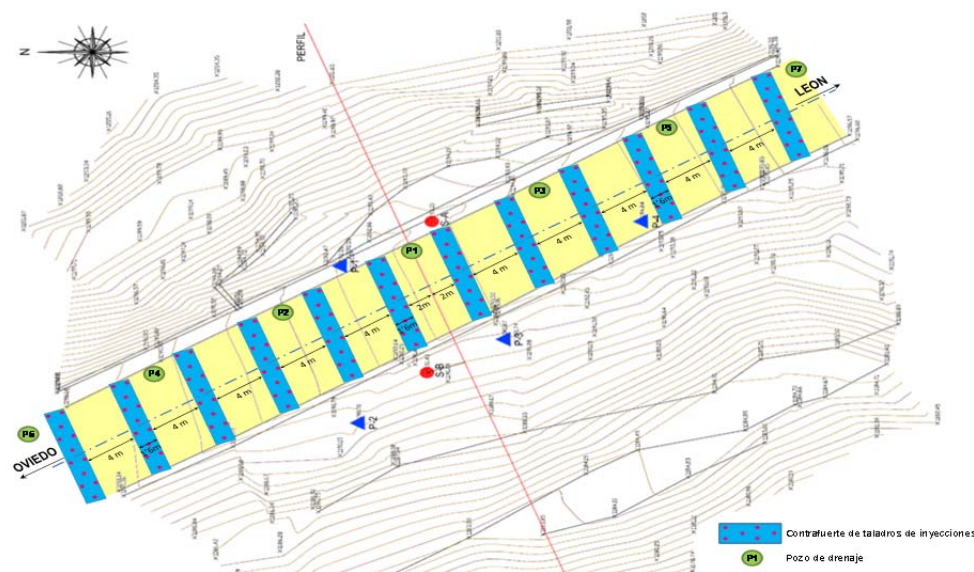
Planta general con contrafuertes de inyecciones armadas y pozos drenantes.
